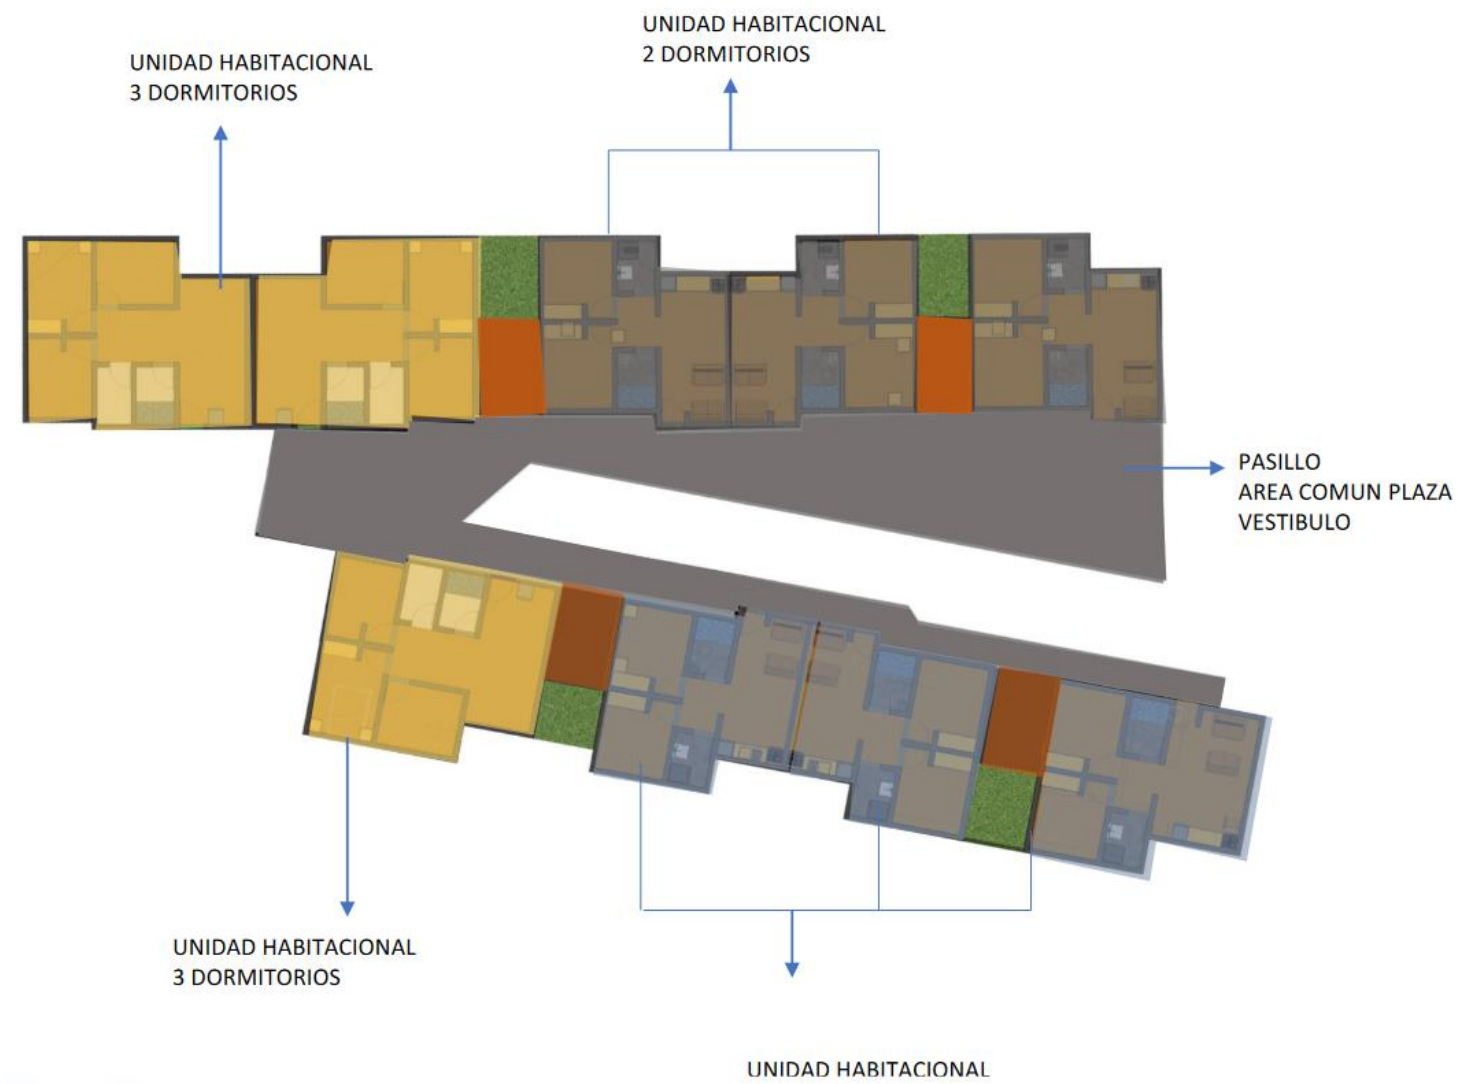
Planta Residencial El Fortín. Fuente: Peralta, J. (2018). Plan Integral de Intervención en Guararí, Pág. 112.
